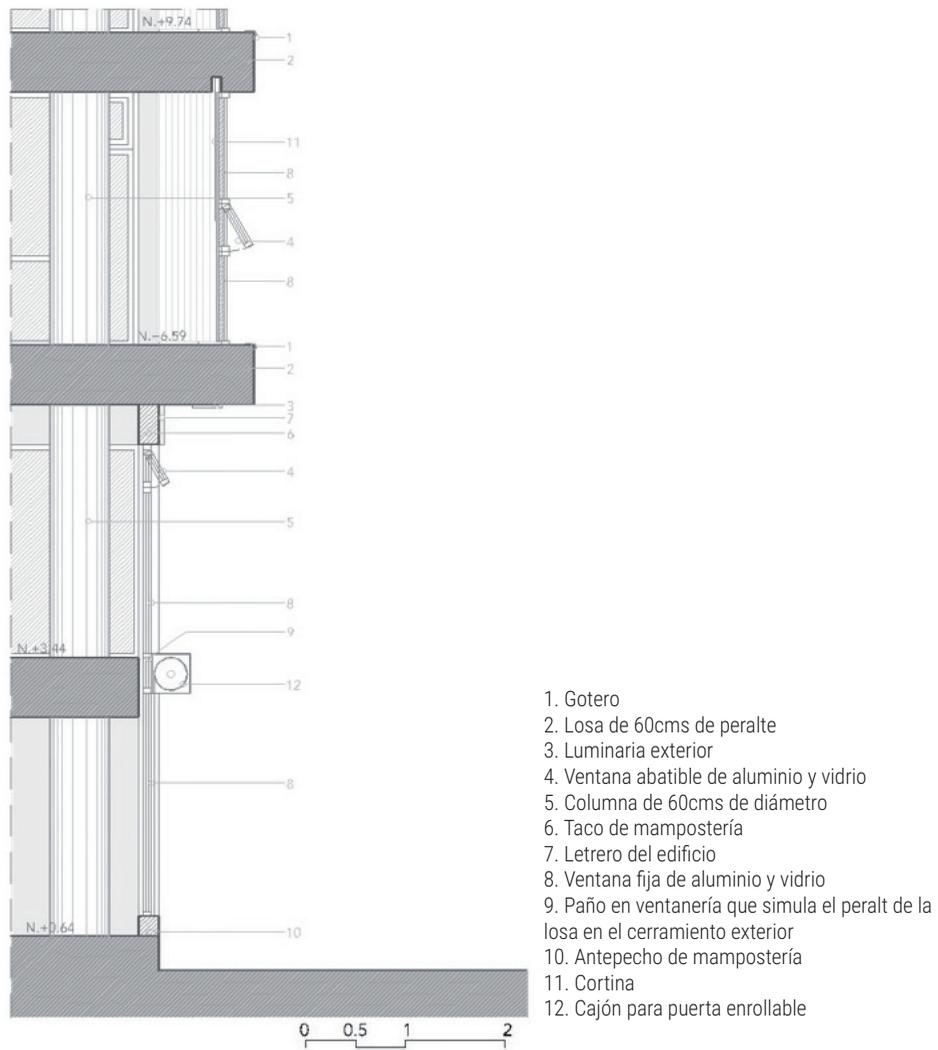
Sección constructiva en la fachada lateral sobre la calle García Moreno
